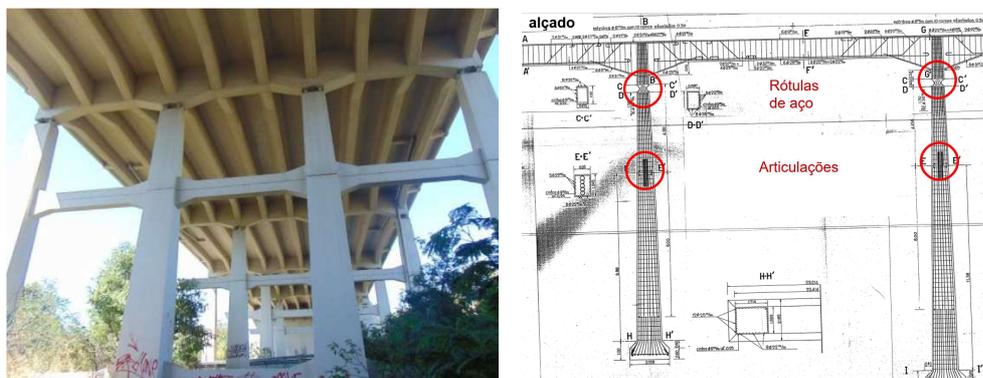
Vista dos pilares do viaduto com articulações ao nível da travessa marcadas por uma junta e extrato do desenho de projeto mostrando as articulações em causa.
